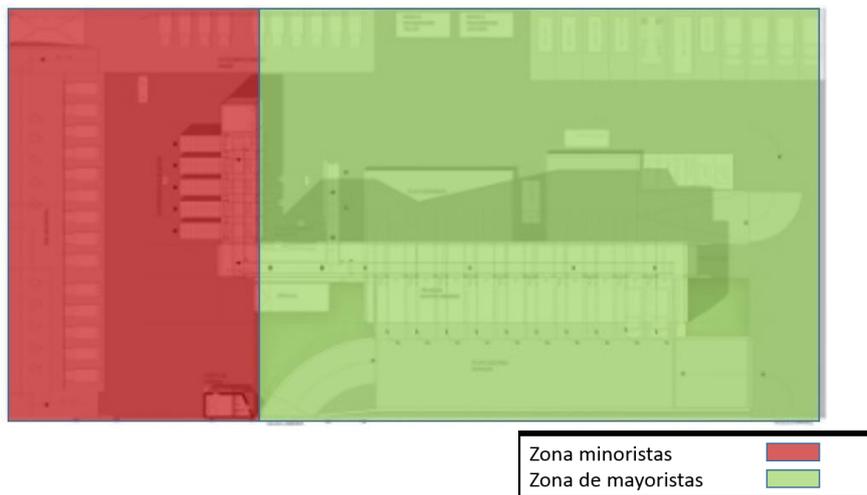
Vista en planta, de la planta de residuos sólidos punto verde. Fuente: www.peruarki.com, 2014, edición: propia 2017
